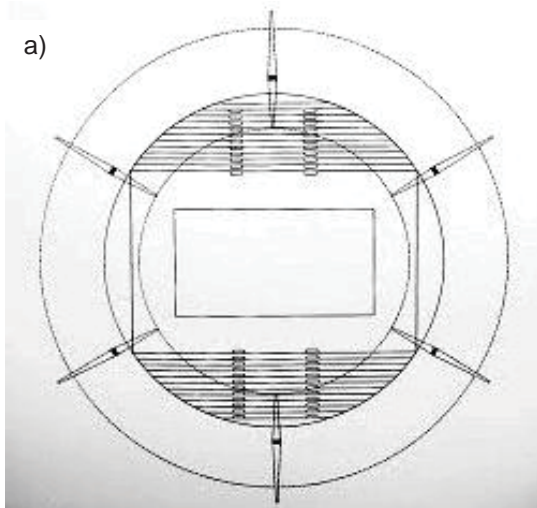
a) Planta indicando seus seis pilares de concreto; b) Cobertura.
